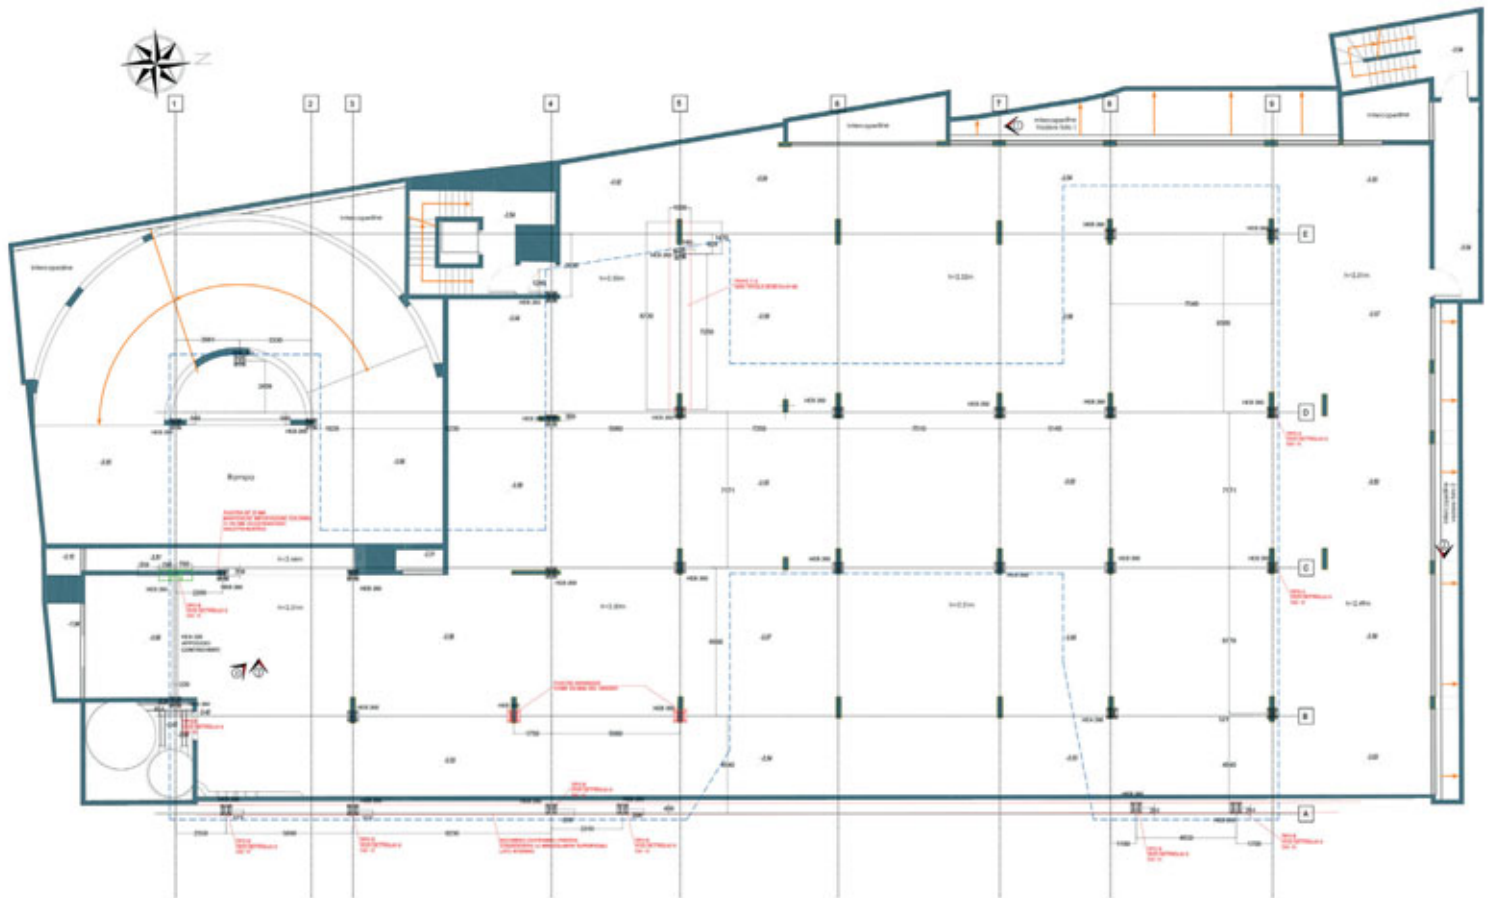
Pianta strutturale del parcheggio interrato e posizionamento dei pilastri dell'edificio Pichi 12. © Carpenteria S.A.C.I.F. Srl
